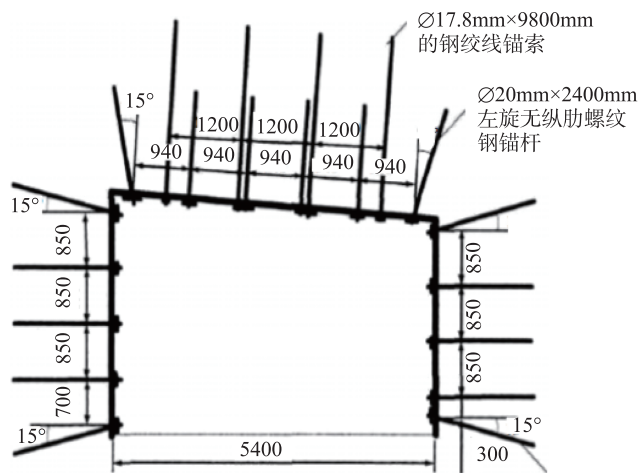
煤矿巷道锚杆支护断面示意图(单位:mm)
